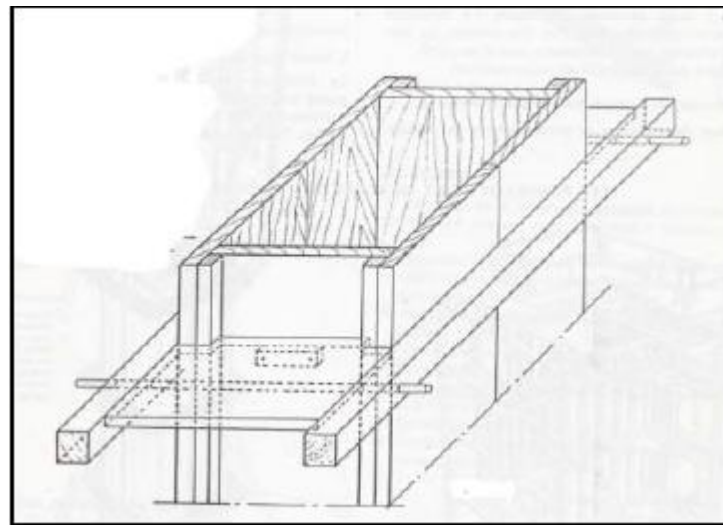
Coffrage en bois pour un poteau de moyenne section
